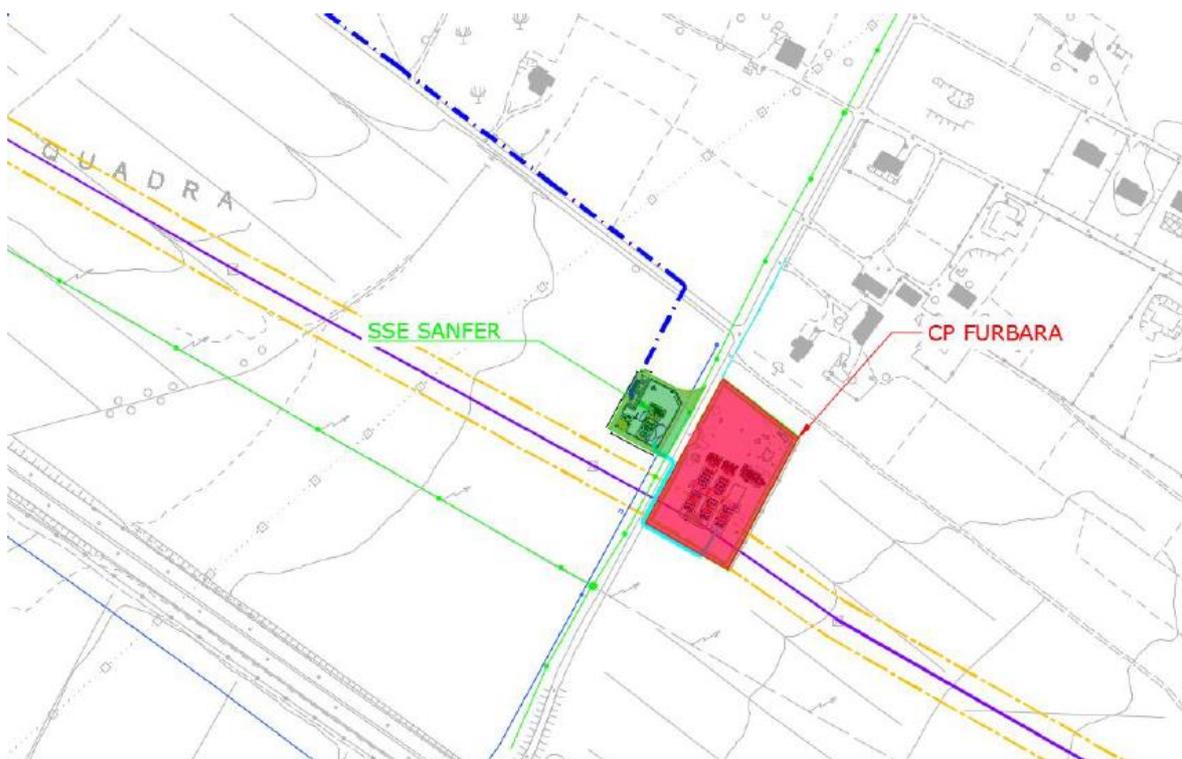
Stralcio di dettaglio su CTR con l'ingombro delle opere: futura Sottostazione (in verde, con accanto esistente CP Furbara oggetto di interventi di potenziamento). Come evidente dall'andamento delle curve di livello, il sito è pianeggiante.
